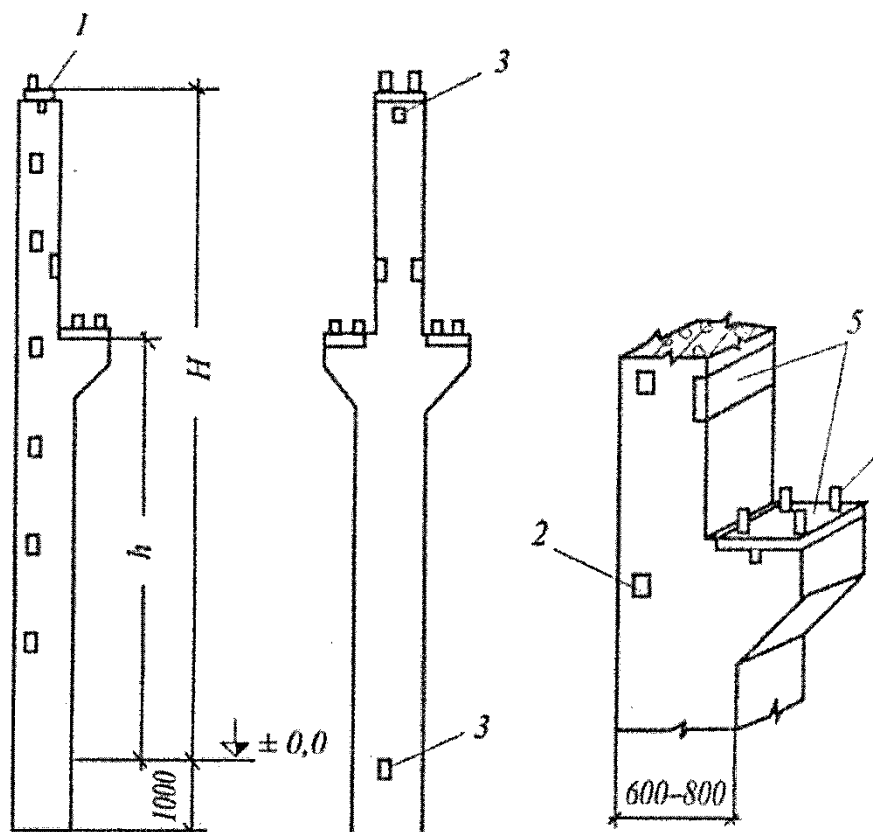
Сборные железобетонные колонны для бескрановых пролетов одноэтажных зданий:
